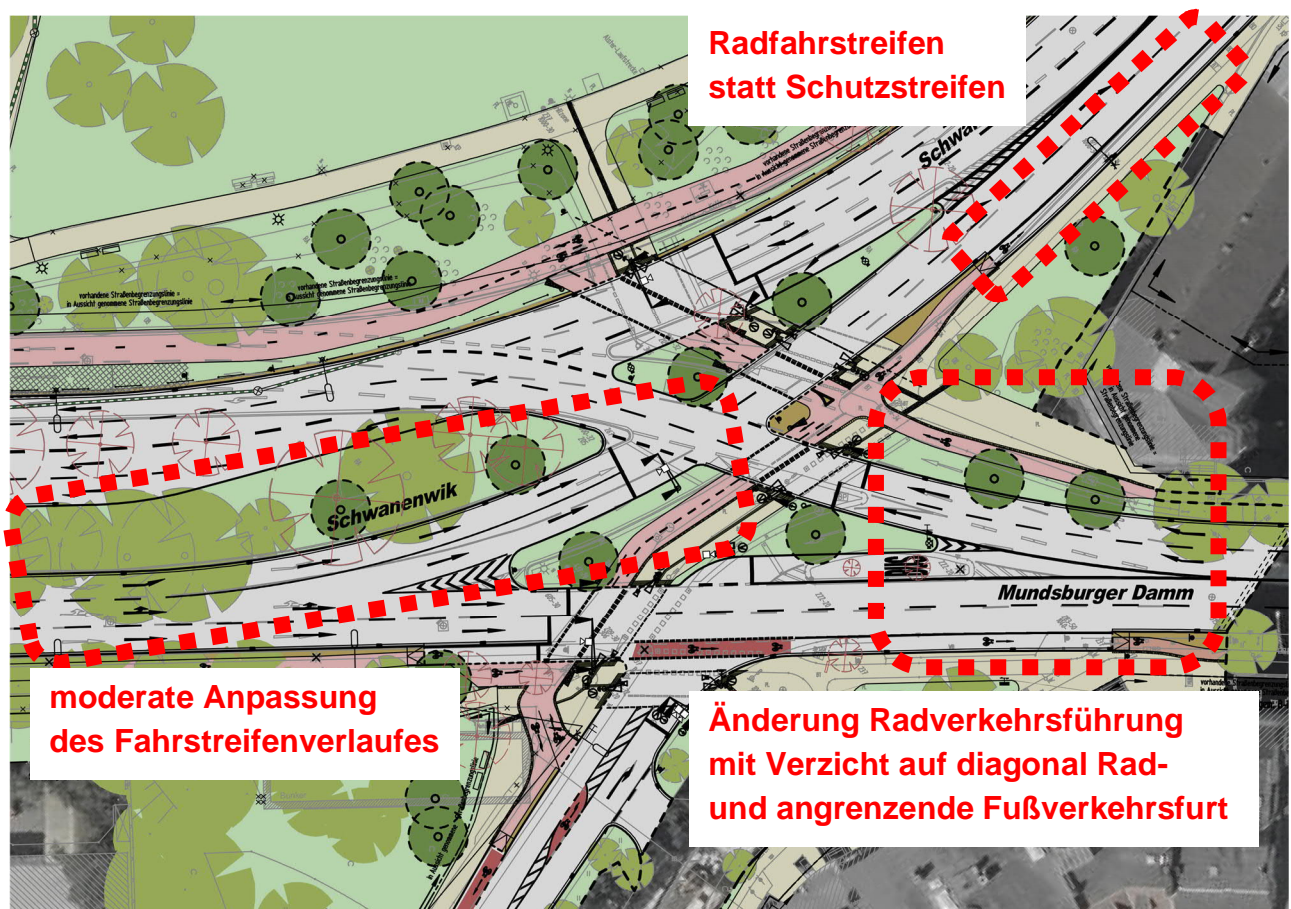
Lageplan-Ausschnitt mit Knotenpunkt Schwanenwik / Buchtstraße / Mundsburger Damm
